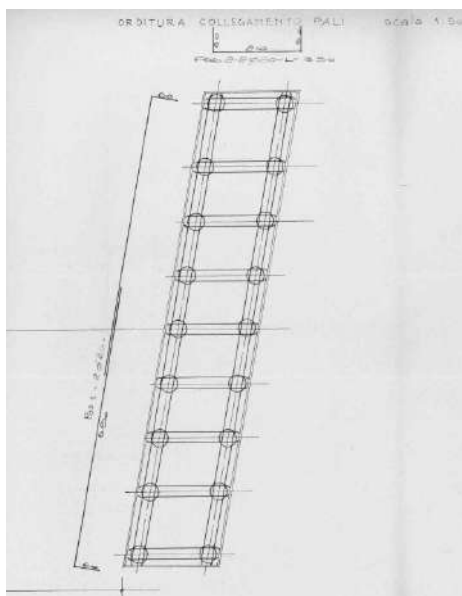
SPALLE PLAUSIBILMENTE CORRETTE PRESENTE NEI PROGETTI DELL'EPOCA
